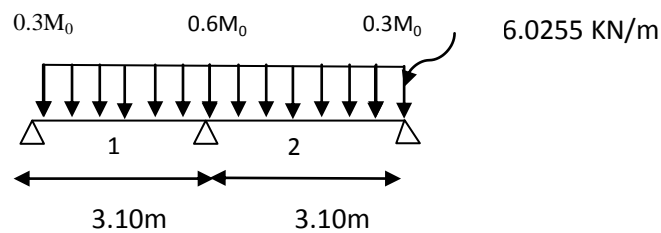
Schéma statique de la poutre continue reposant sur 02 appuis
